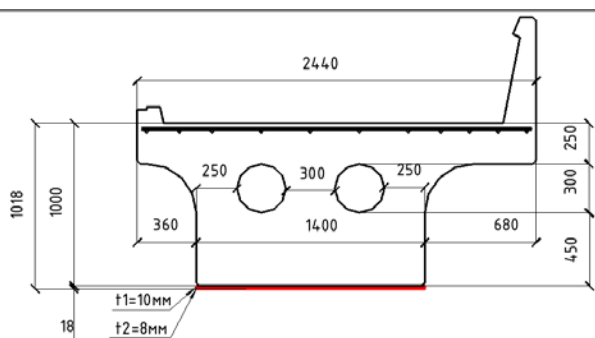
Зовнішнє армування плитної прогонової будови з круглими поздовжніми отворами. Варіант №3
